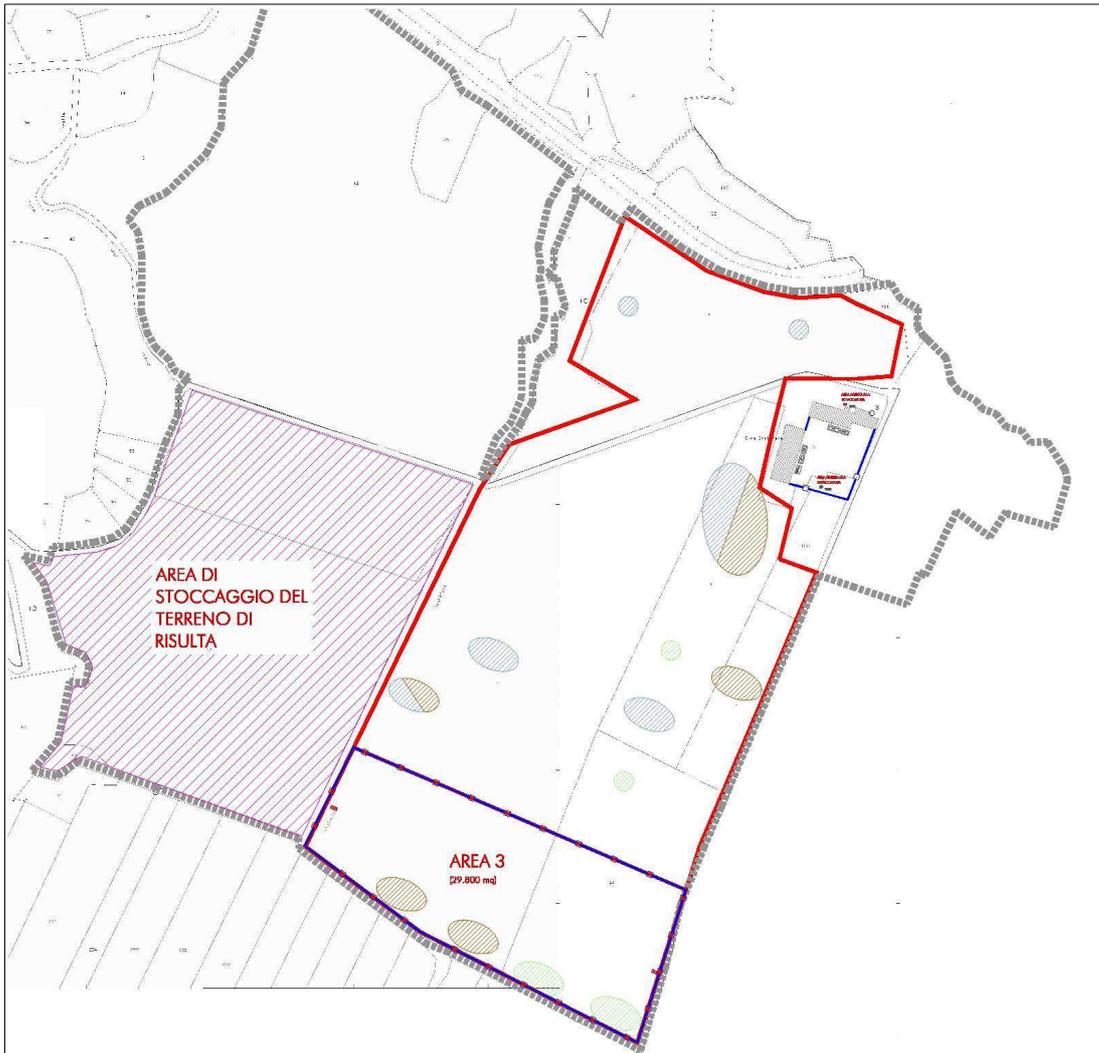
Planimetria generale della quarta fase di scavo – Area 3
